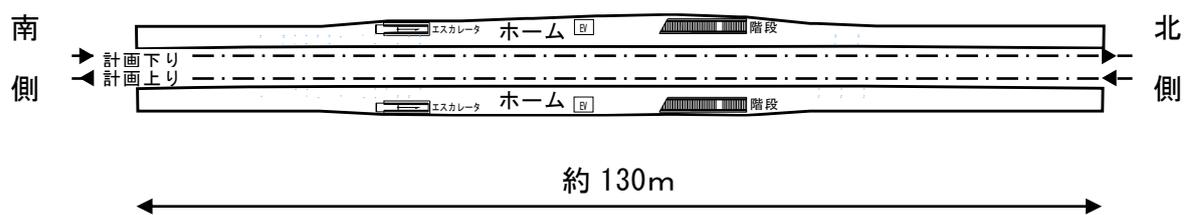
(2) 駅部概略平面図 (鹿島田駅)
